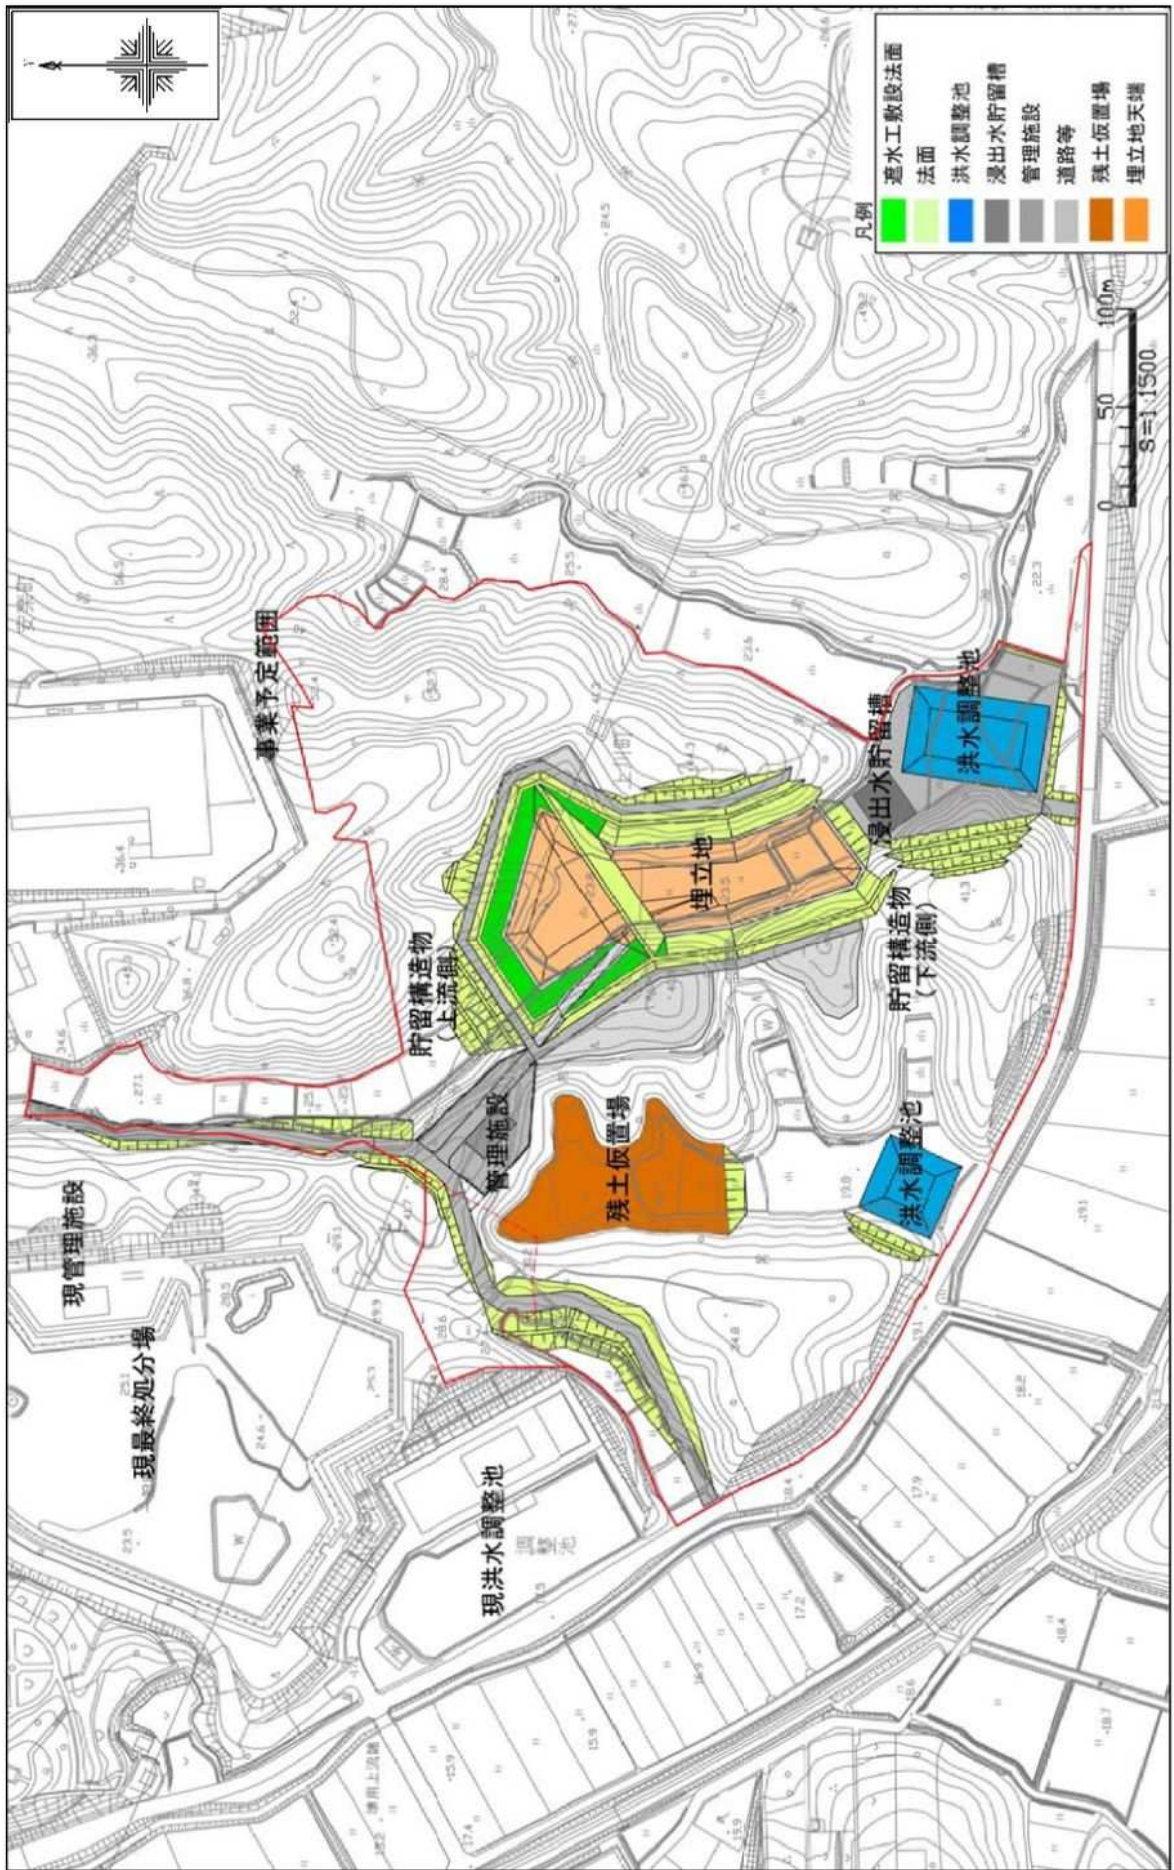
(2) 新最終処分場配置平面図 (第 2 期)
